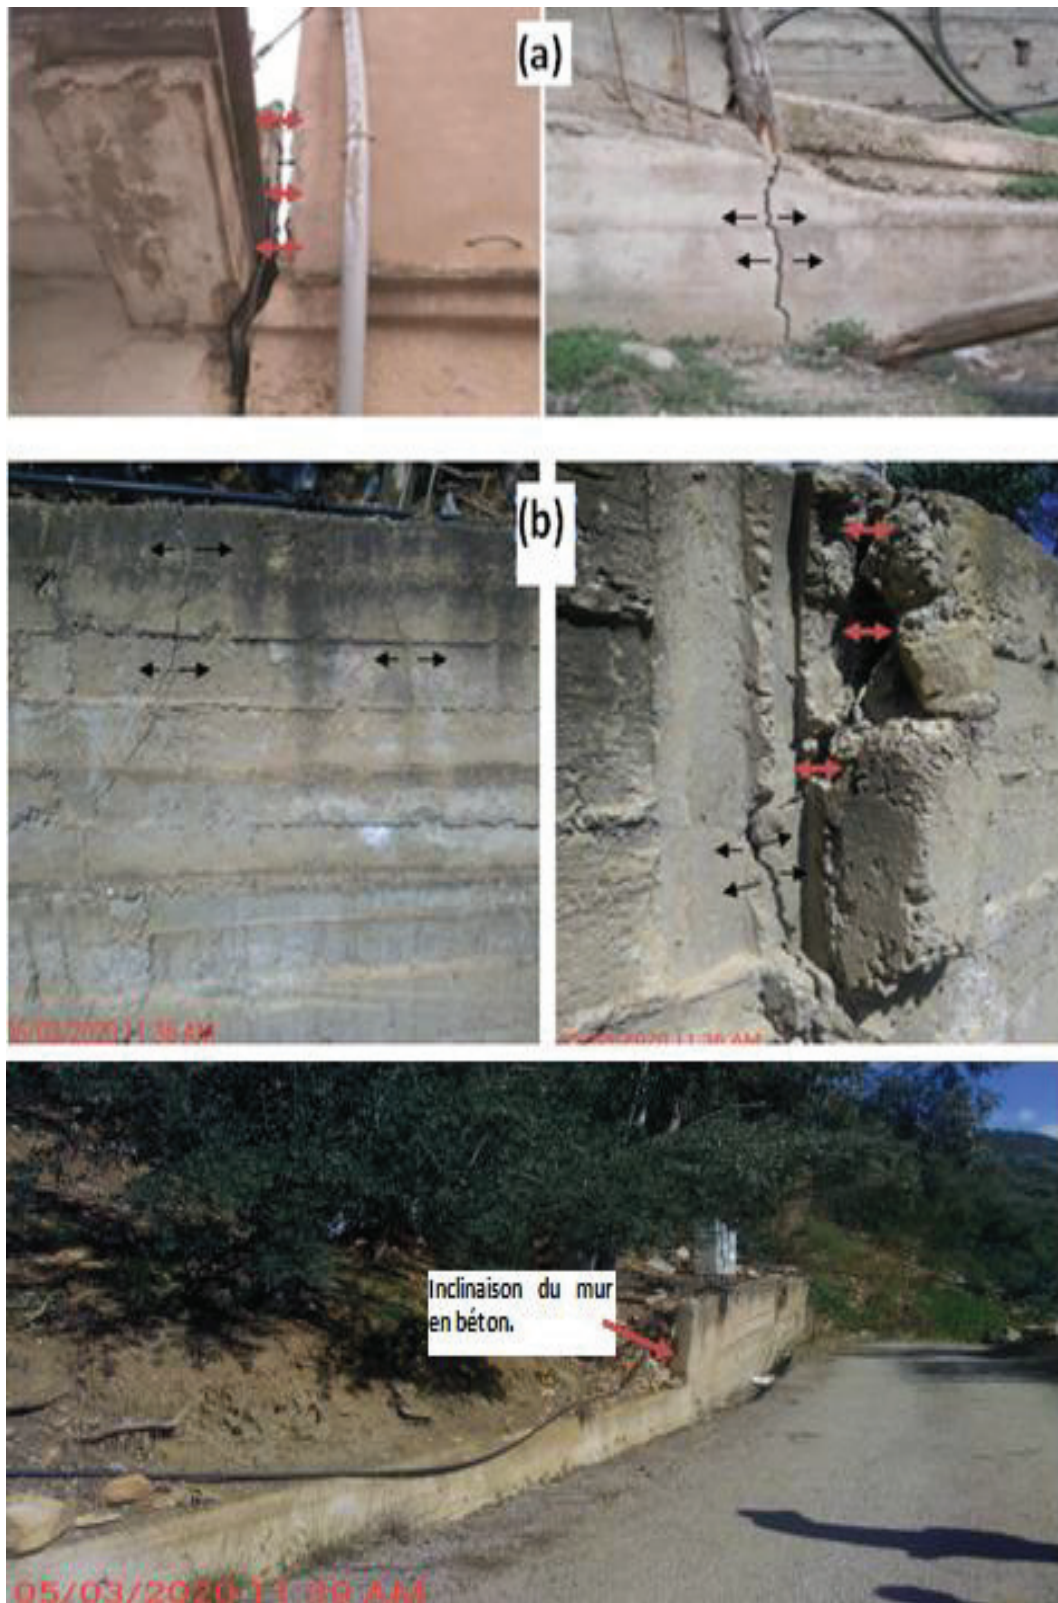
Ouvverture et écartement des joints, fissuration de mur en béton et son inclinaison
